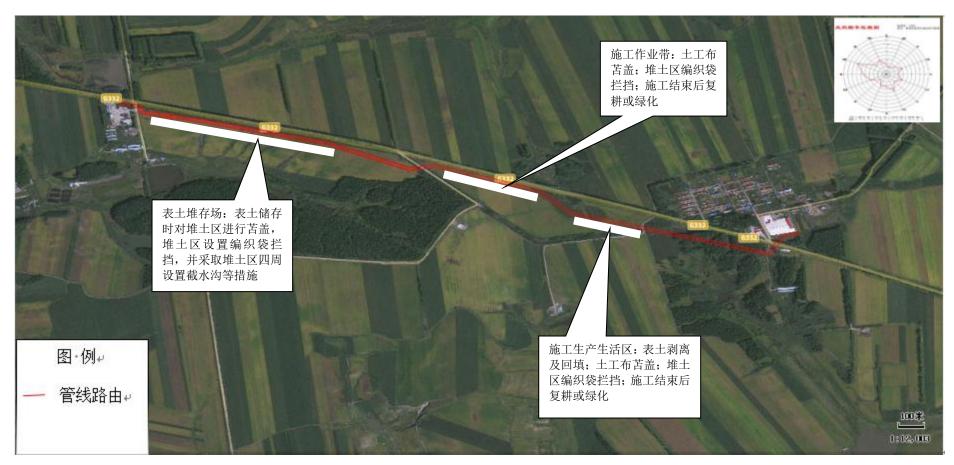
施工总平面布置图及主要生态保护措施分布图
